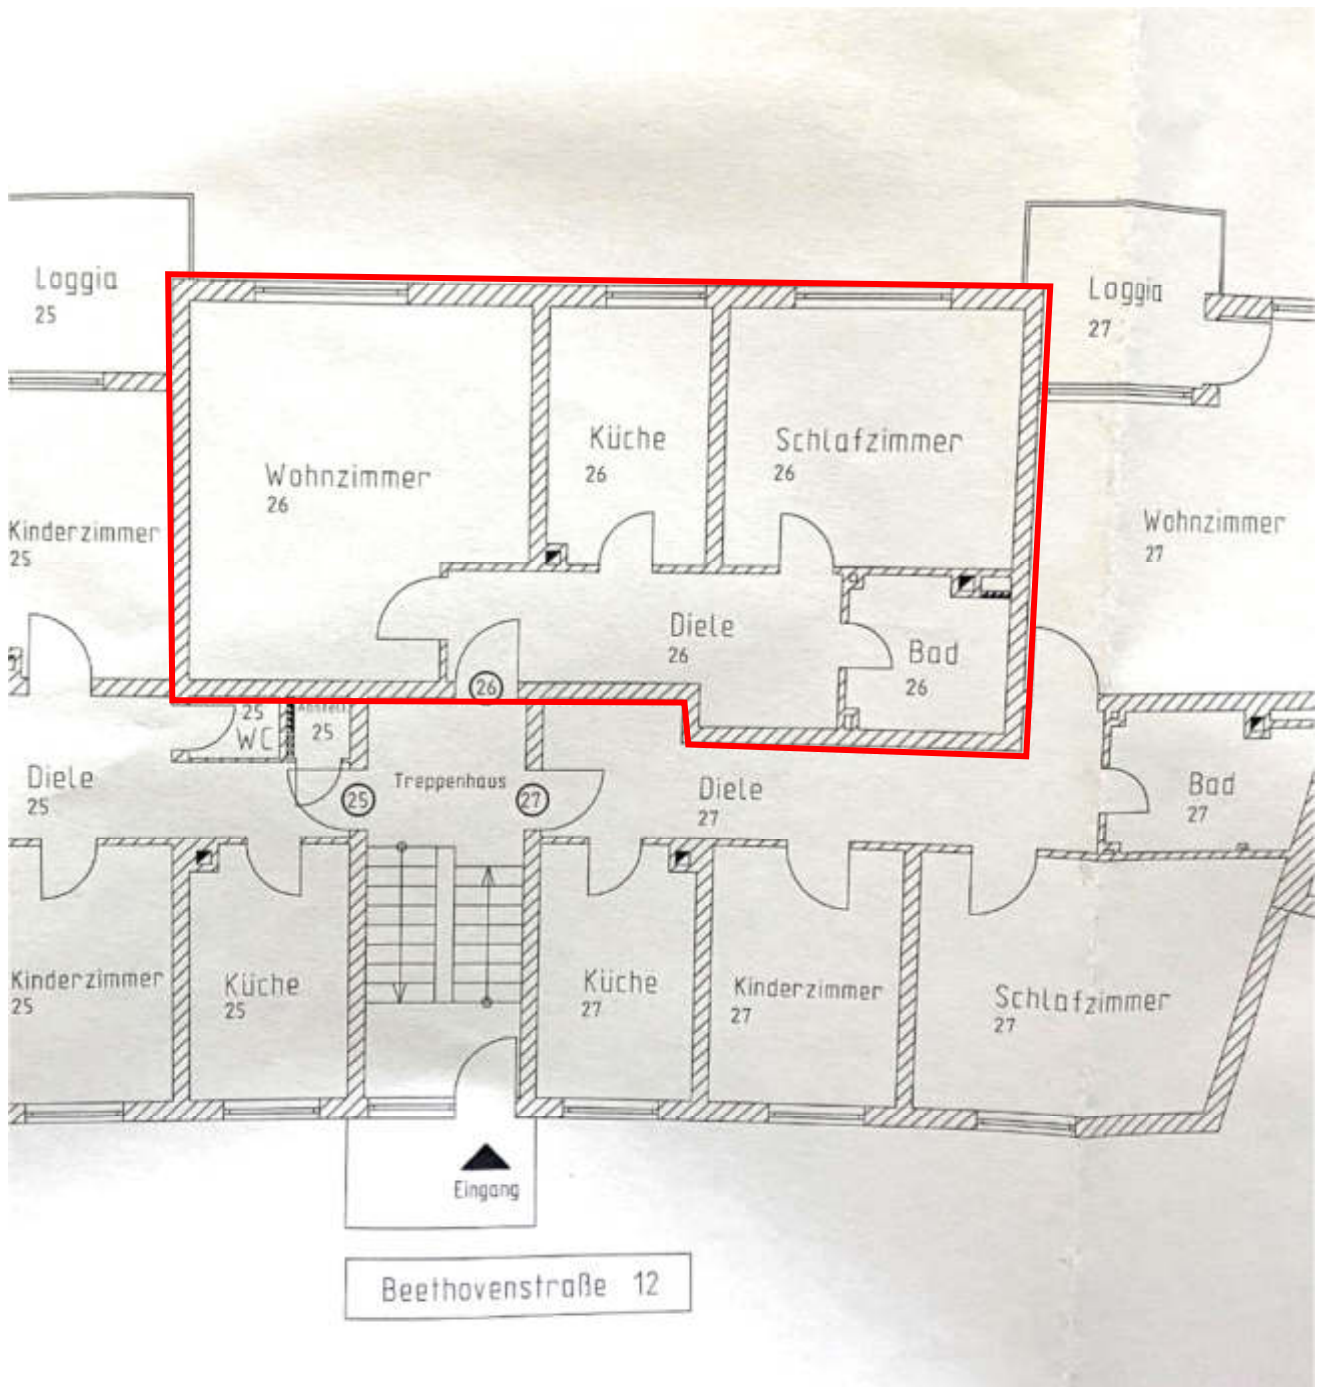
Grundriss Erdgeschoss Beethovenstraße 12 (ohne Maßstab); Detail Wohnung 26; Quelle: Teilungserklärung vom 04.10.2001, Aufteilungspläne; Roteintragung durch den SV
